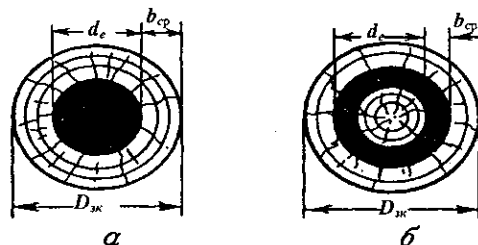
Умовний переріз деталі дерев'яної опори: а - при повному внутрішньому загниванні; б - при частковому внутрішньому загниванні
